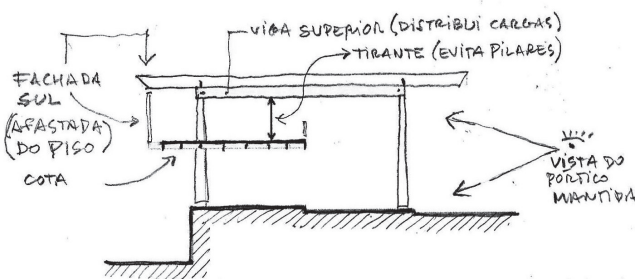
| Croqui da estrutura metálica; Figura 14 | Croqui da "bandeja" elevada
